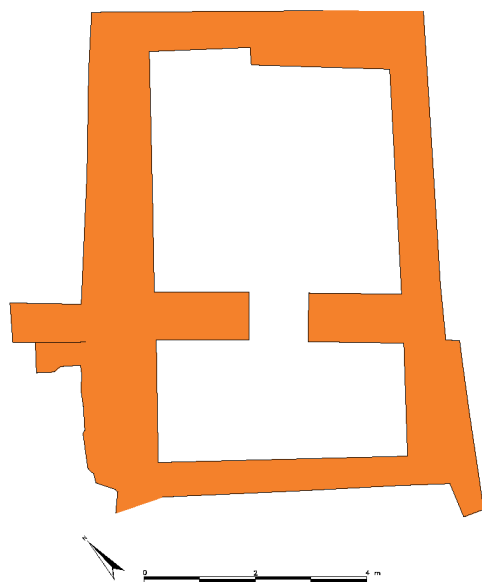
a Hellenistisches Brunnenhaus, Grundriss
